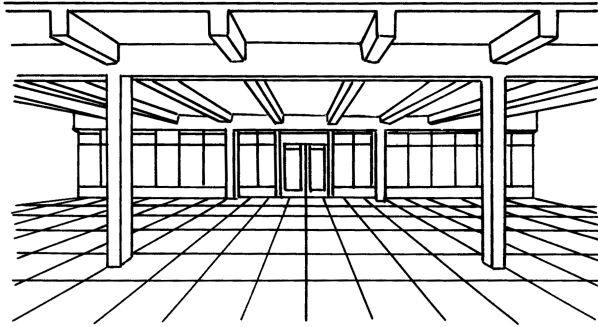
7 整体式钢筋混凝土肋梁楼盖
